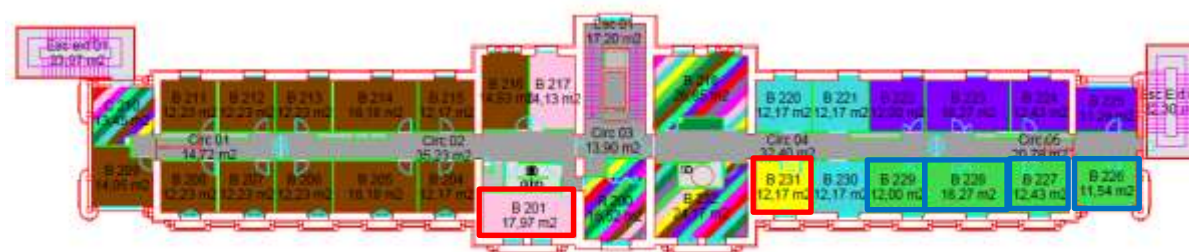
Plan du R+2 pavillon TAILLEFER - plan d'occupation 2020
